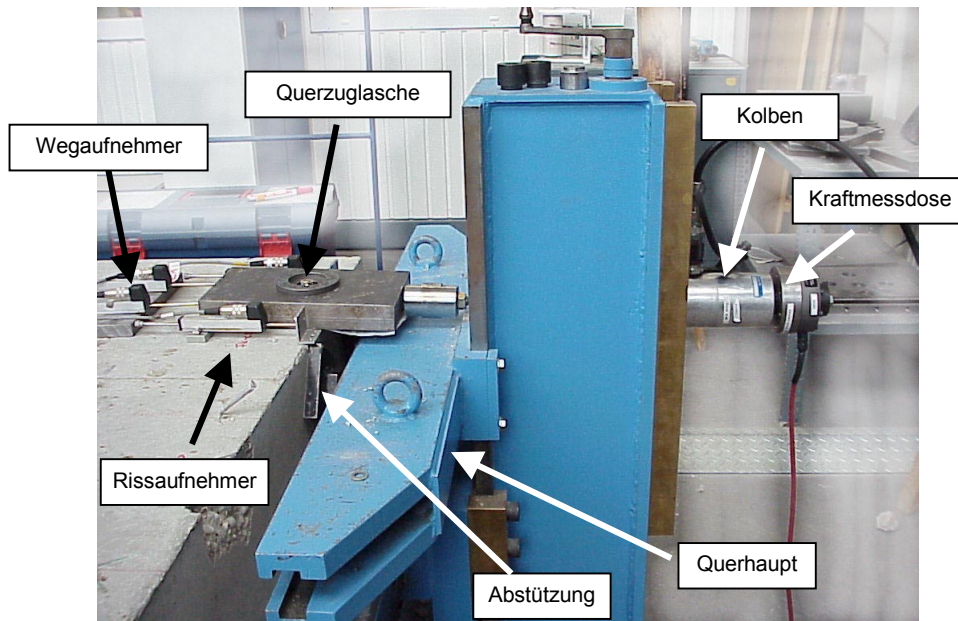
Belastungseinrichtung für Querlastversuche am Bauteilrand und in der Bauteilfläche im ungerissenen Beton.
